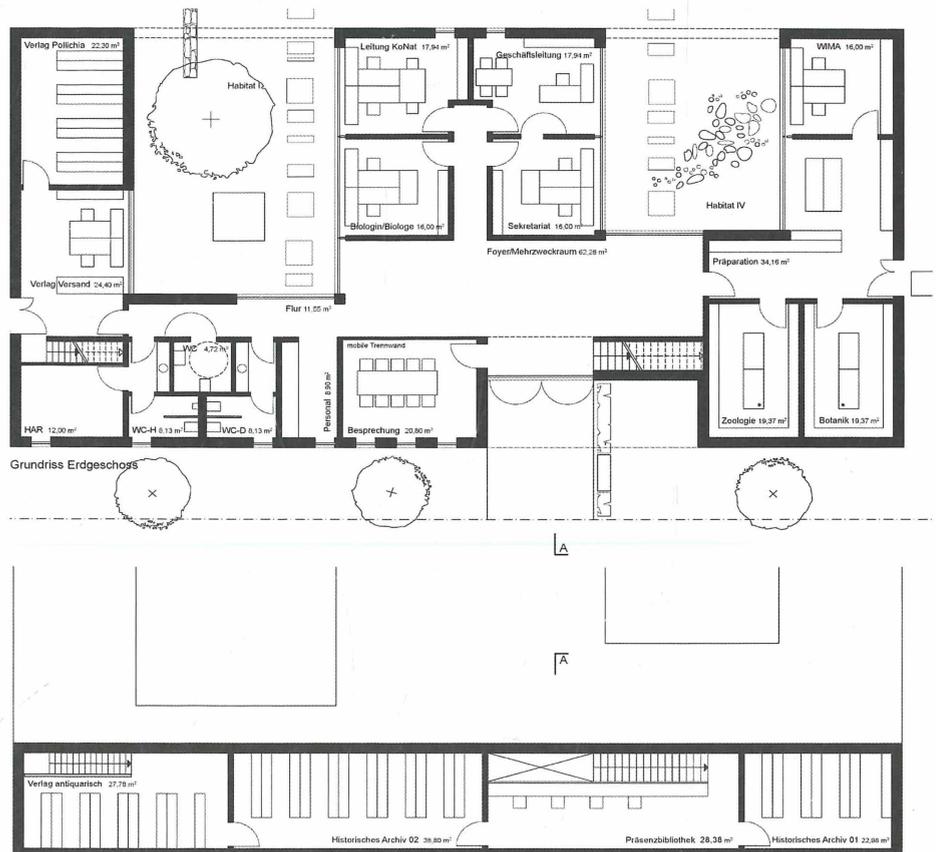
Grundriss von Erdgeschoss (s. oben) und Obergeschoss (unten)
